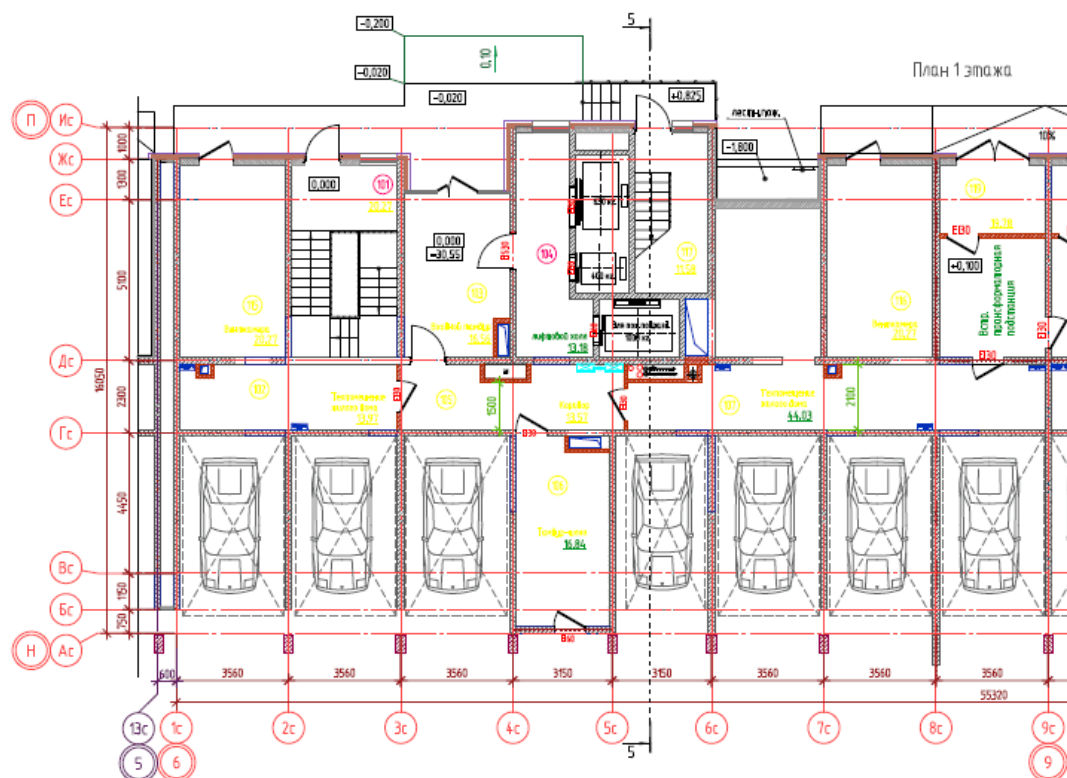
План 1 этажа БС-6 ЖК URAL
